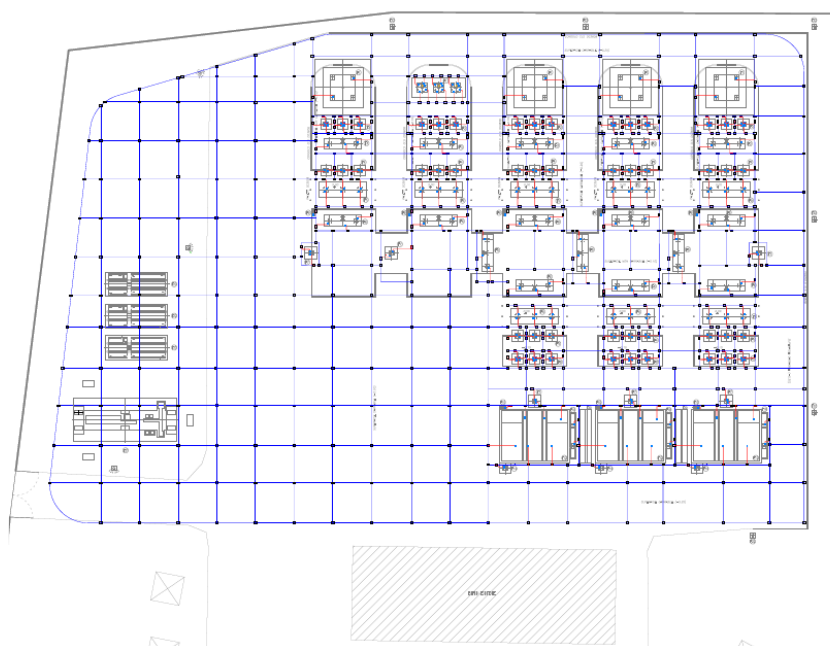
Stralcio planimetrico rete di terra cabina primaria Venosa
